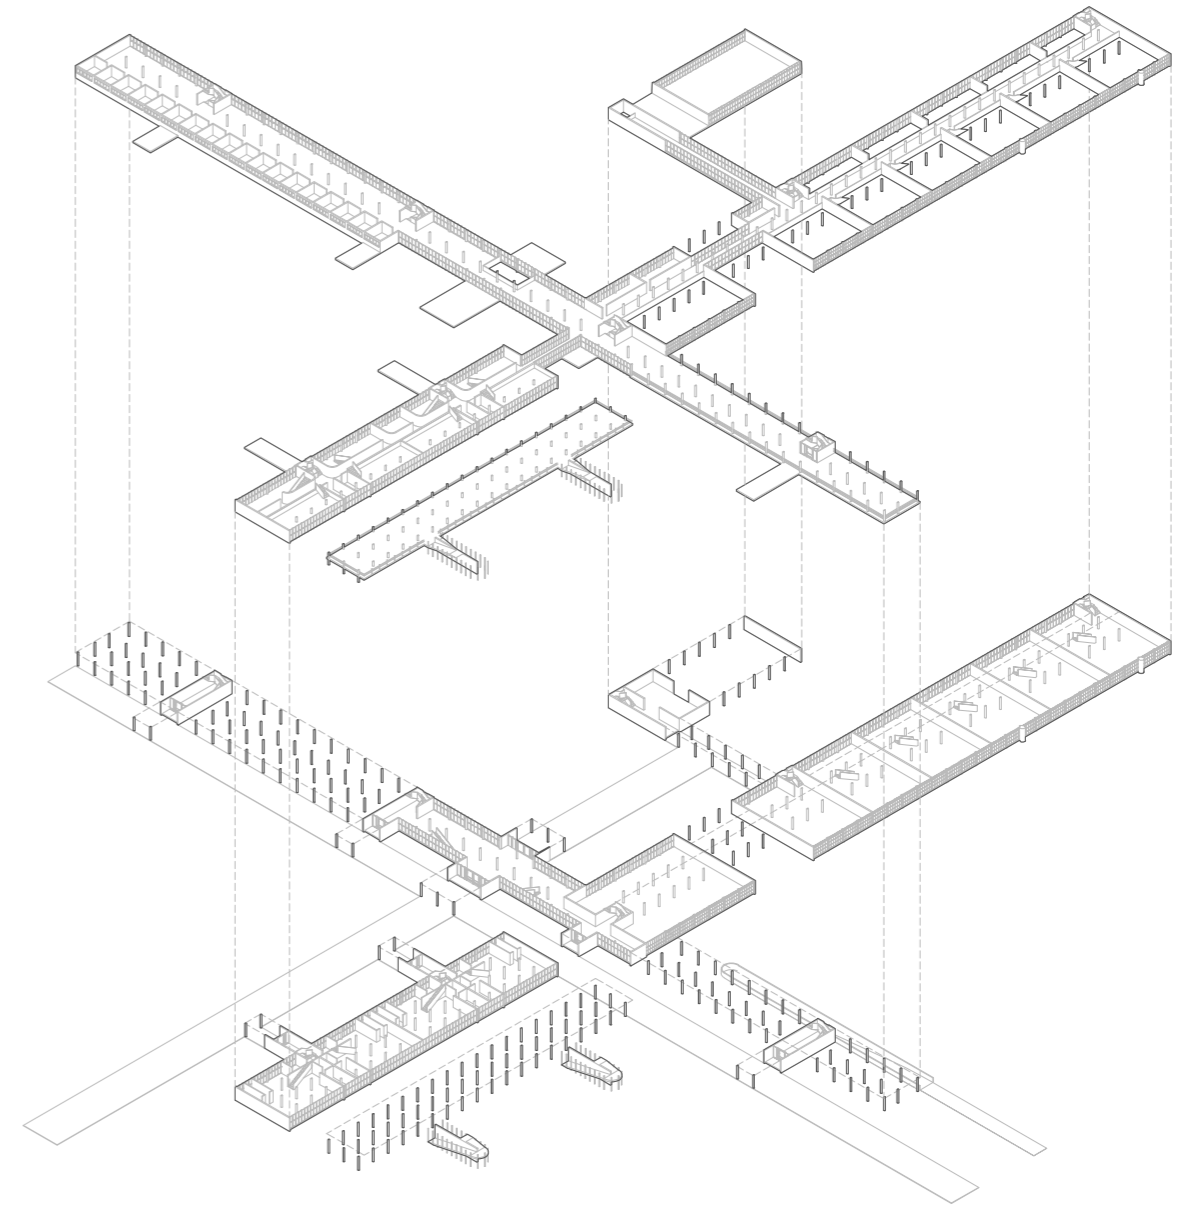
Axonometría seccionada a nivel. Planta baja y planta primera.
